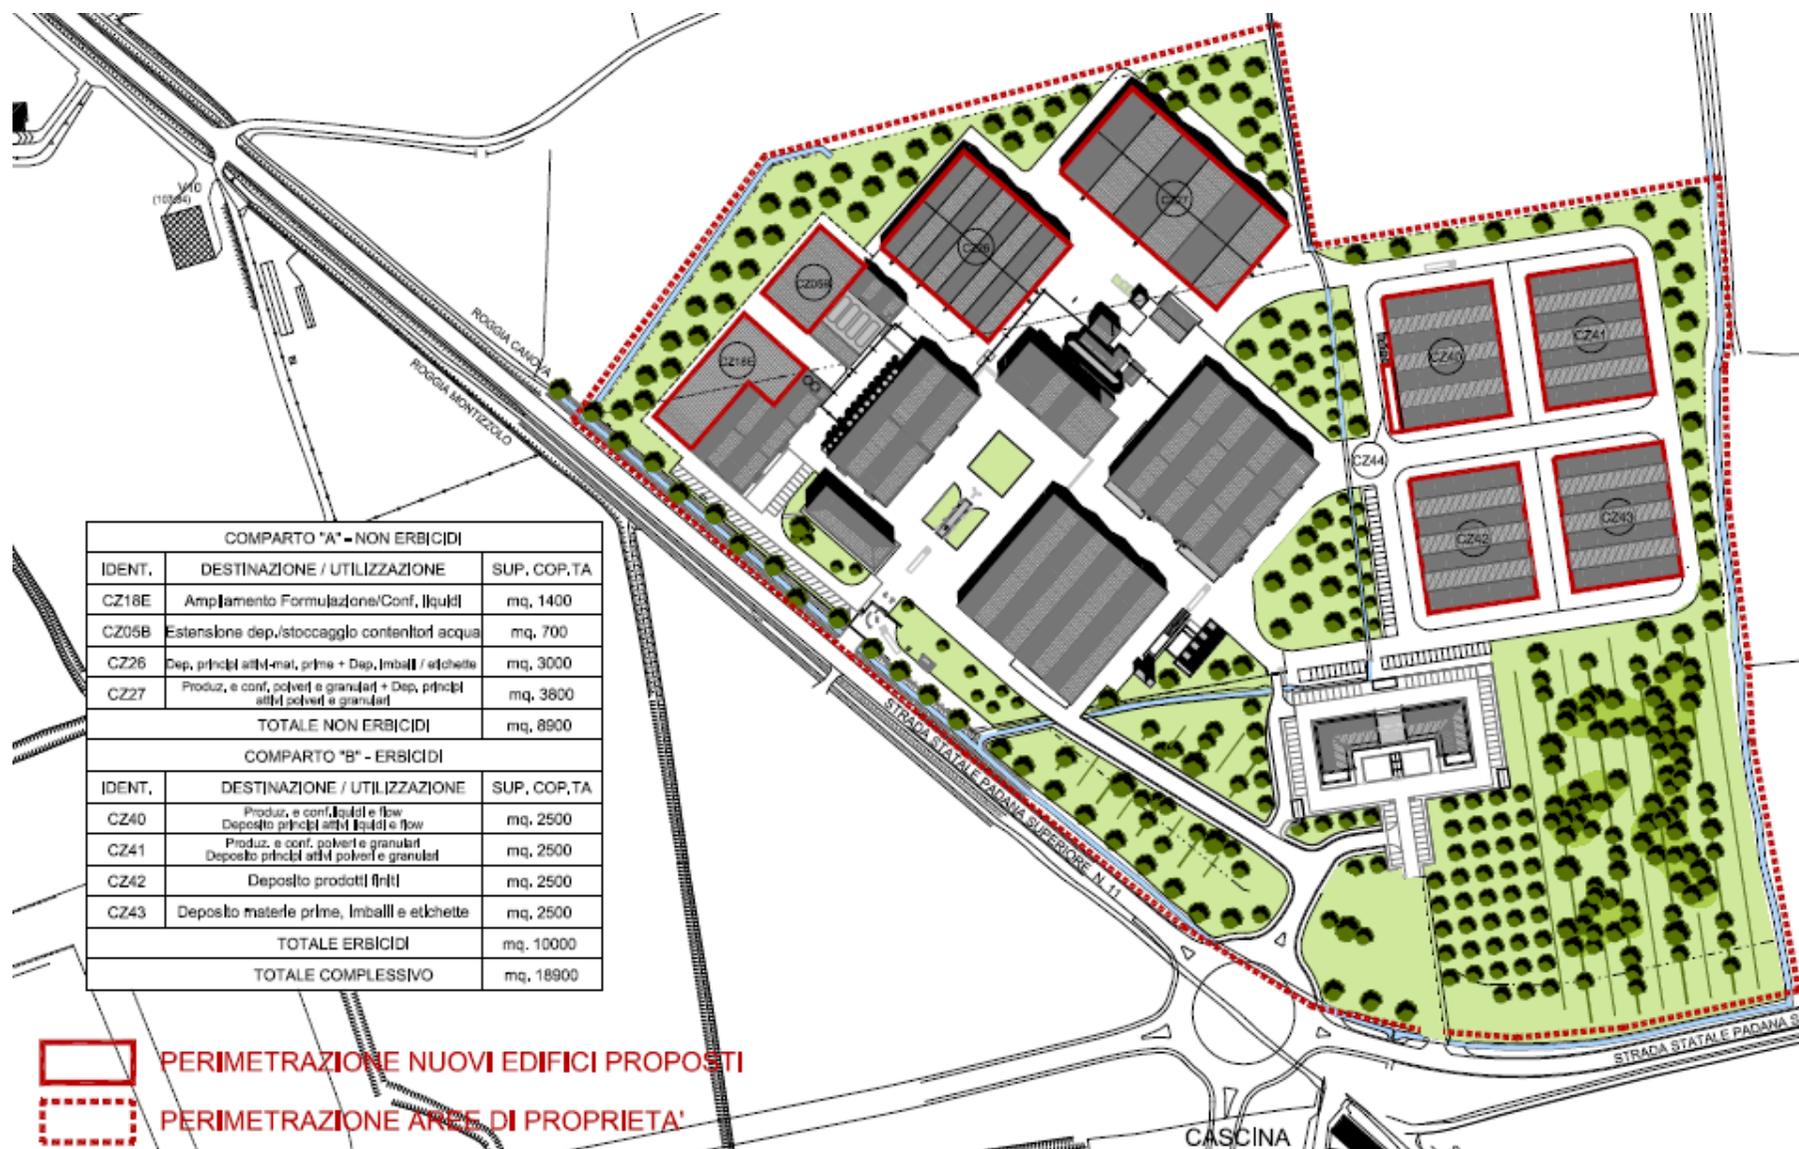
planimetria generale richiesta di trasformazione urbanistica (in variante al PGT)
